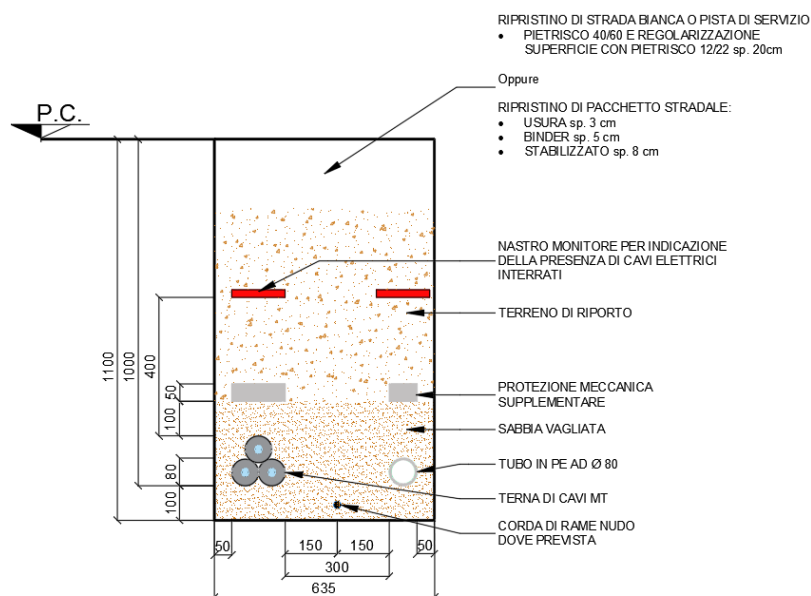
Sezioni di scavo tipo previste per la posa del cavidotto.
